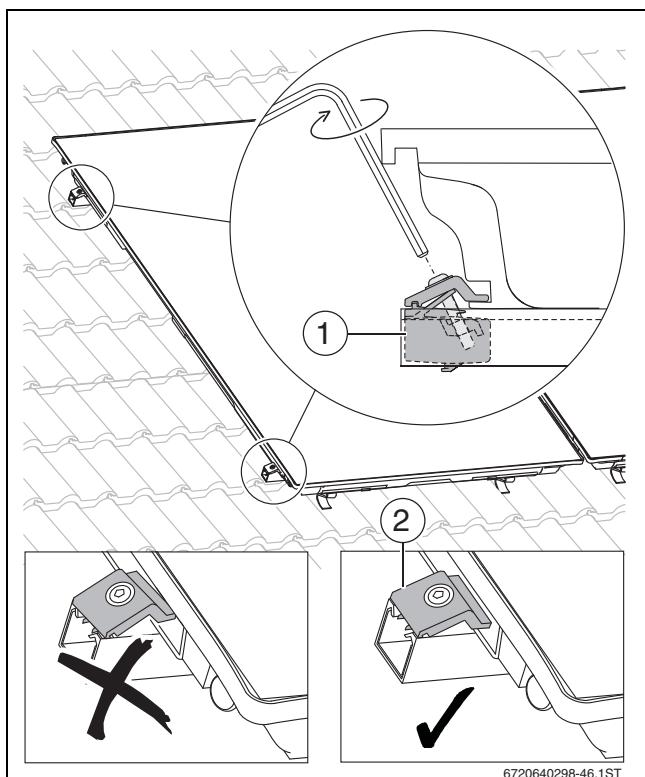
Installazione del terminale di fissaggio sul lato sinistro
